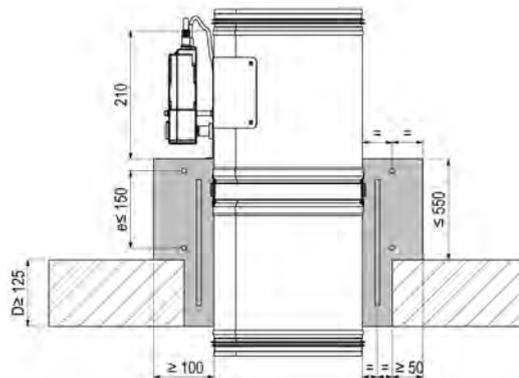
Einbau in massive Decken mit Betonsockel, Schnitt
